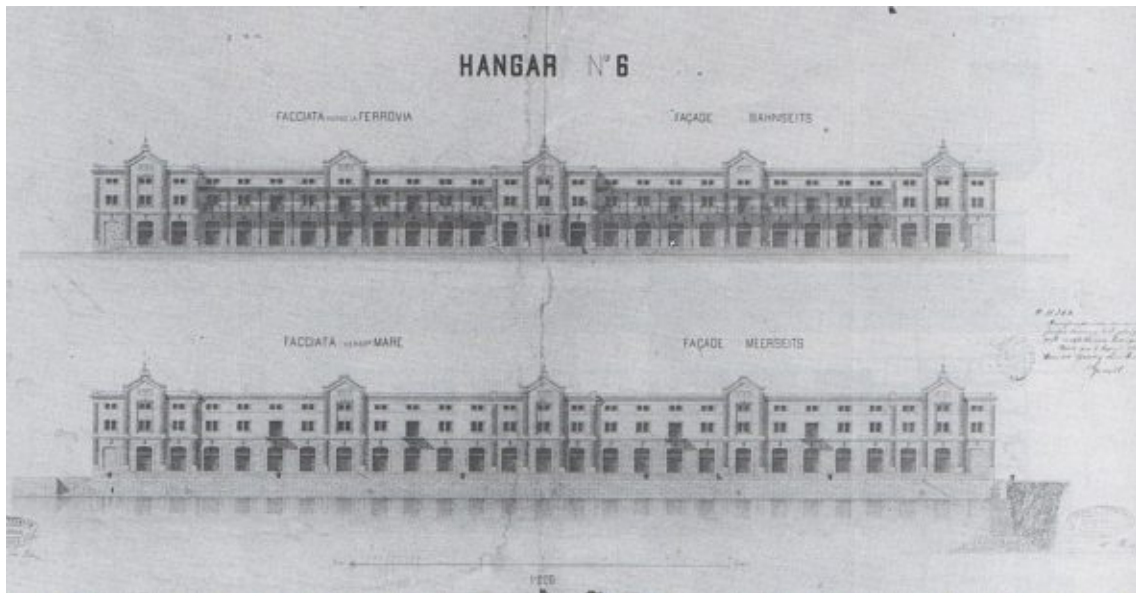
Hangar 6, Fassadenansicht. Oben, Fassade Richtung Bahngleisen.
